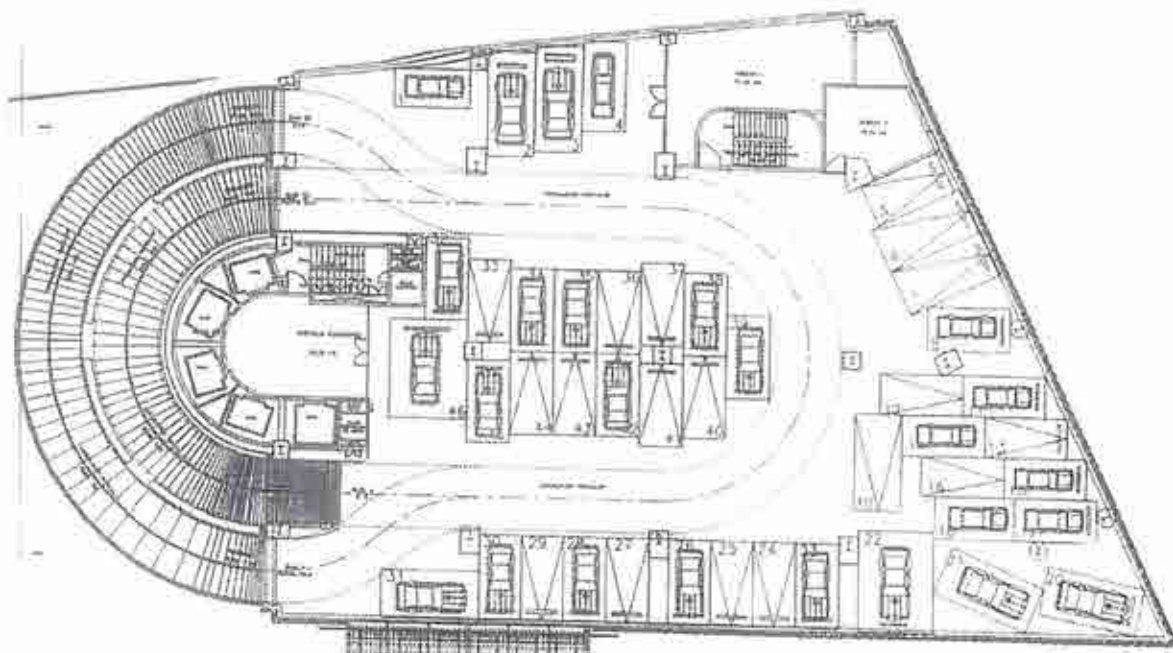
Planta arquitectónica Estacionamiento superior tipo.
